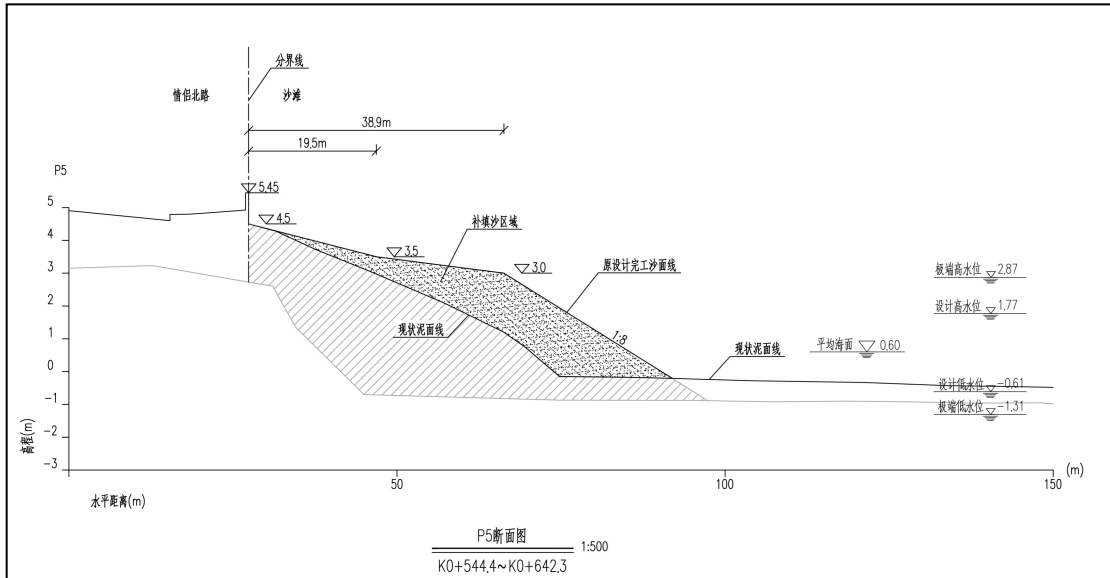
典型的补砂设计断面图 2 (P5 断面图)
